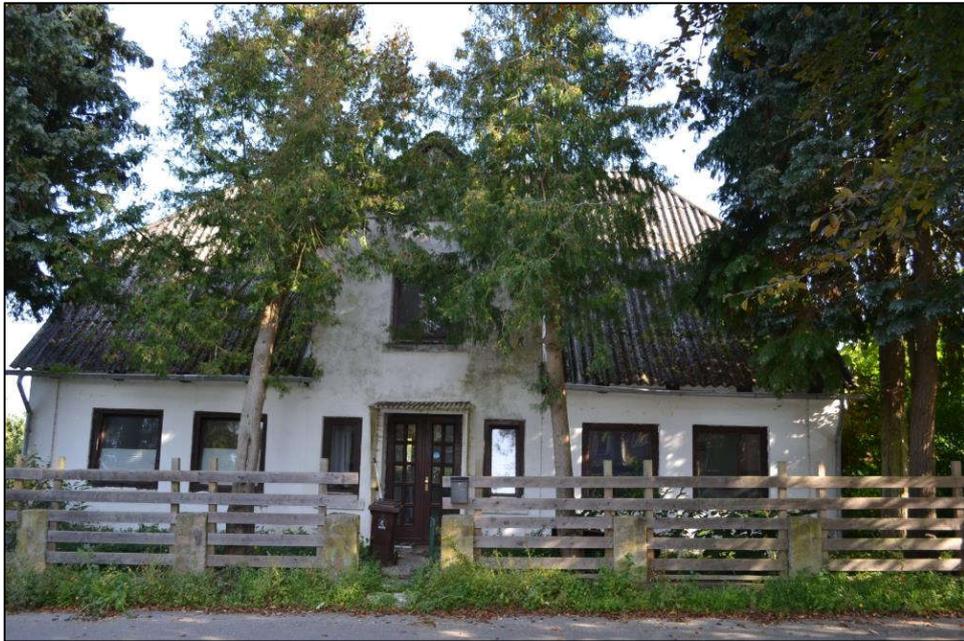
Straßen- bzw. etwa Südwestansicht des Wohnhauses
